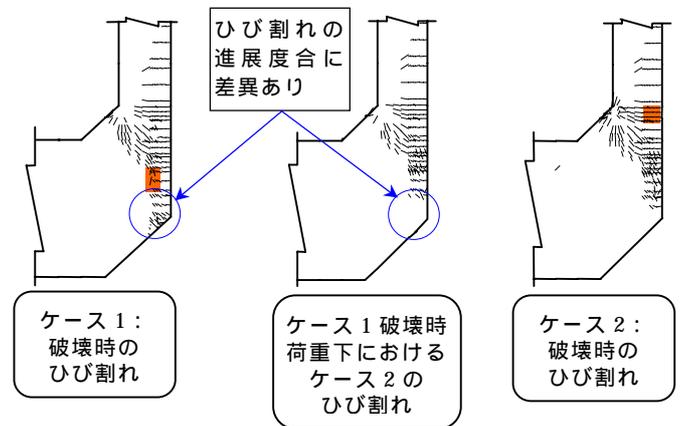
ひび割れ，破壊箇所 (図中の ■部が破壊箇所)
